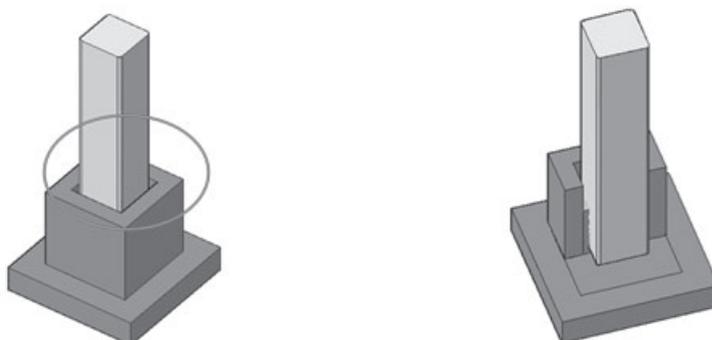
Rimozione della malta di riempimento tra plinto e pilastro.
